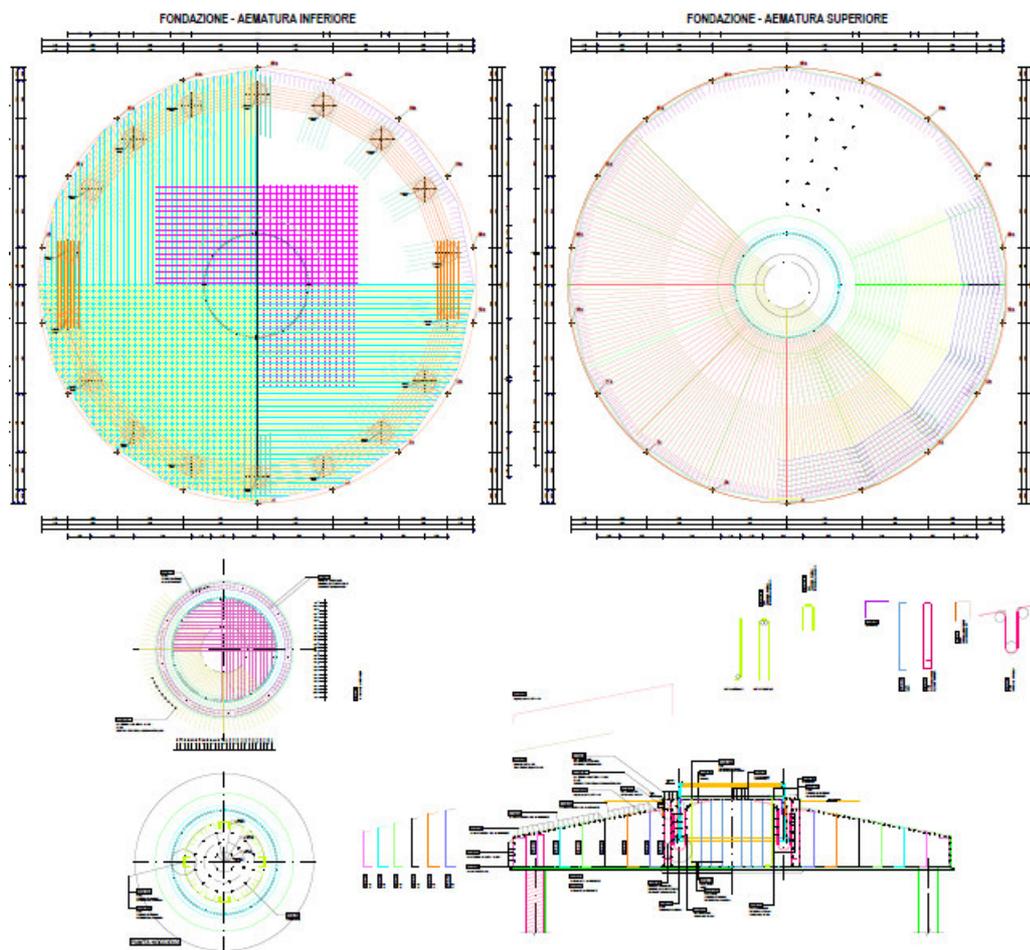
Pianta-sezioni e armature del plinto di fondazione
